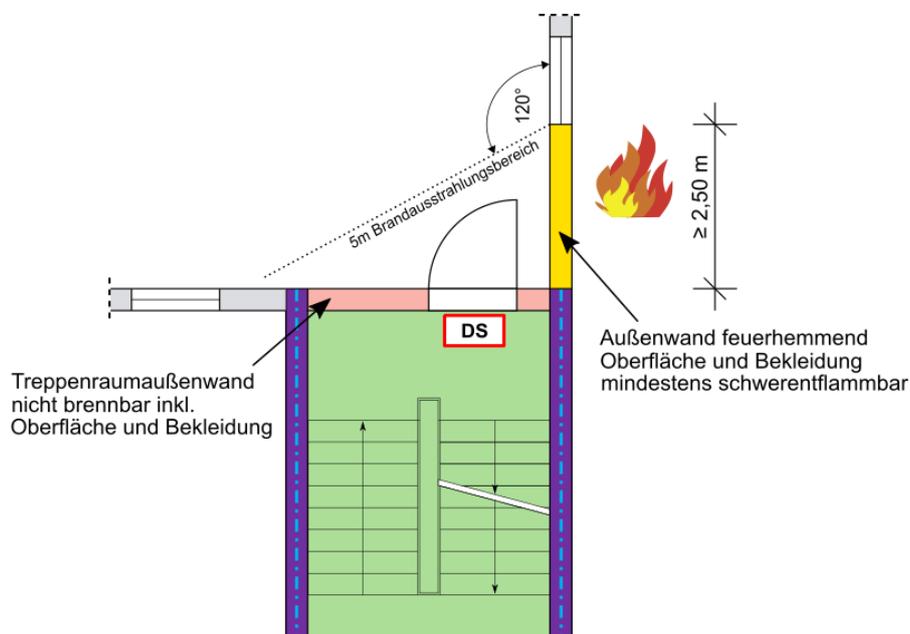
Prinzipskizze (Grundriss) - Ausgang eines notwendigen Treppenraumes in einer Gebäudeinnenecke mit über Eck angrenzenden Fenstern – Variante 1
